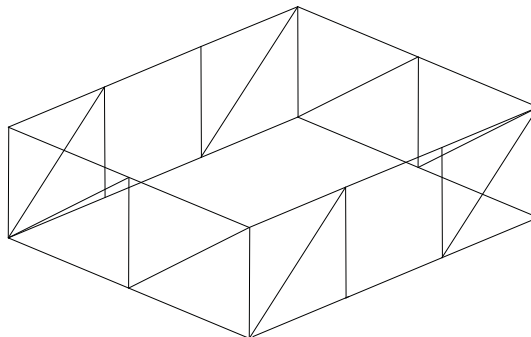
Plan schématique de modélisation de rez-de-chaussée et 1^{er} étage
